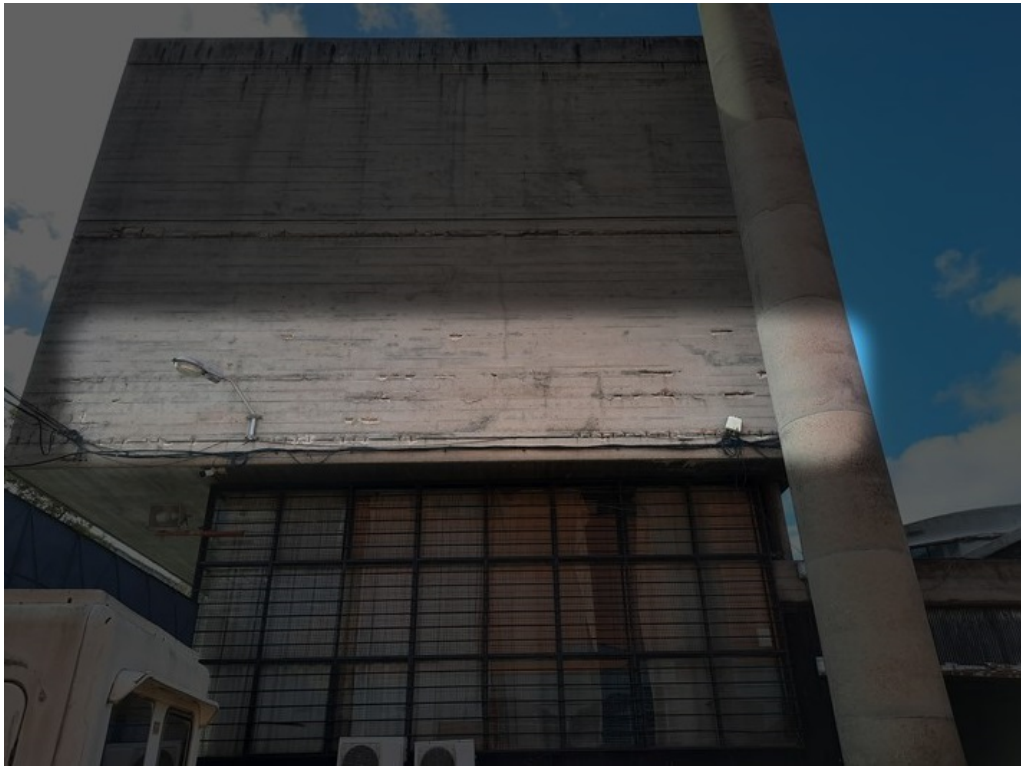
Fotografía del estado actual del muro lateral (Fuente: Relevamiento).
